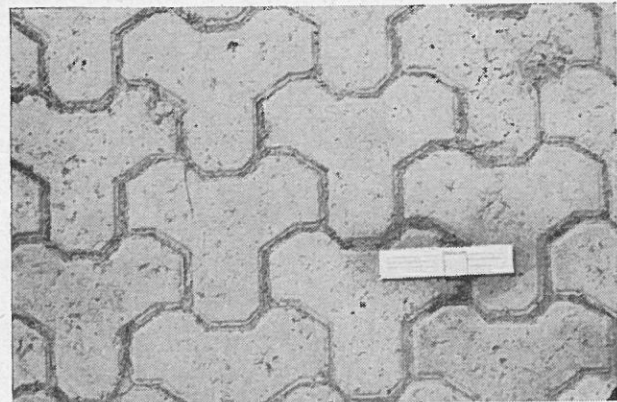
Oberflächenstruktur einer Fahrbahn aus Betonformsteinpflaster
